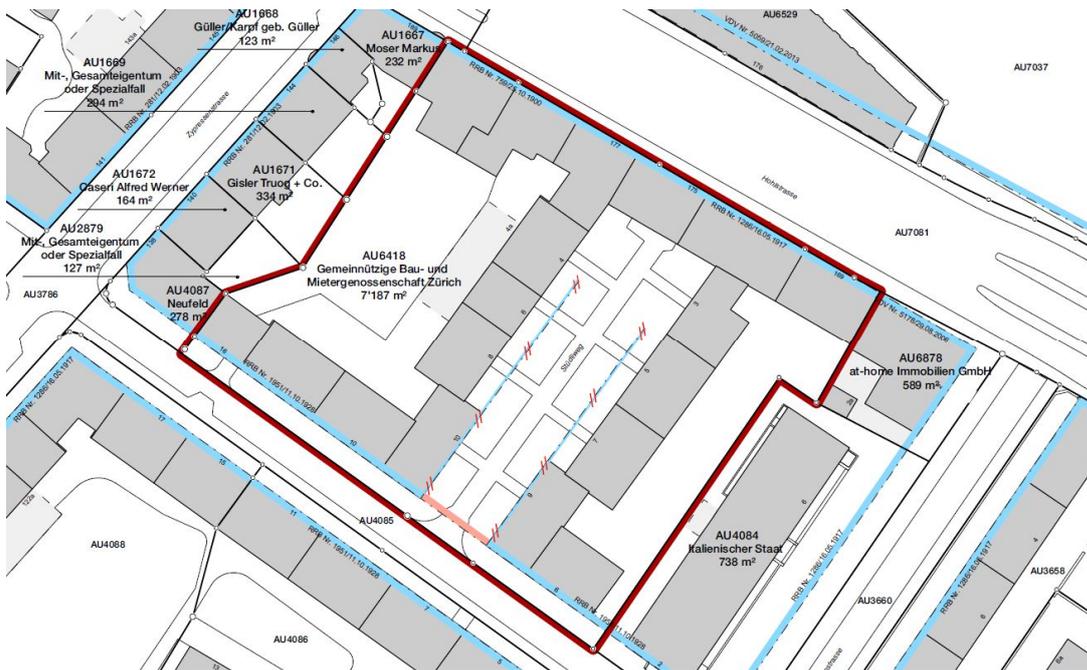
Situationsplan Teilrevision Quartierplan Nr. 160a, Löschung der Baulinien entlang des Stüdlwegs
